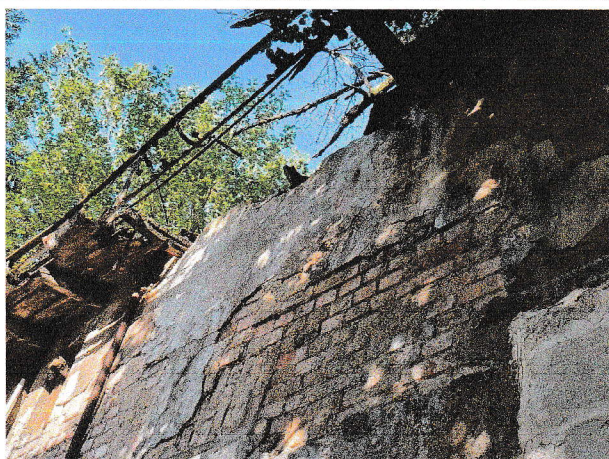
Ubytki zapraw w spoinach muru zewnętrznego
